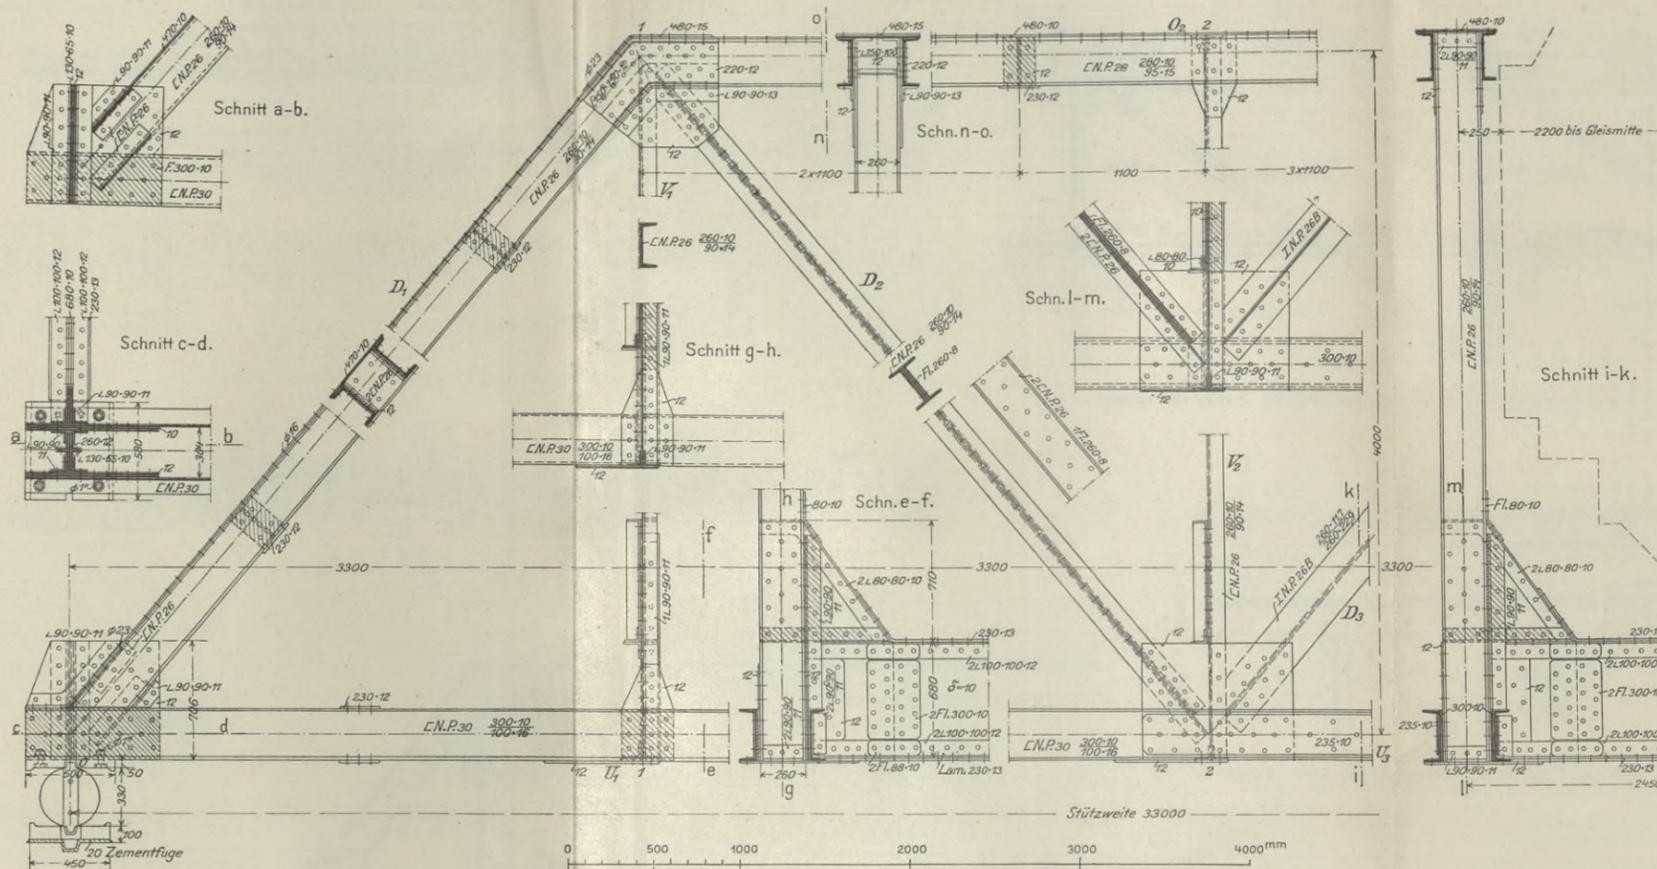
Ansicht des Trägerendes mit dem beweglichen Auflager nebst Schnitten. (1:40)
